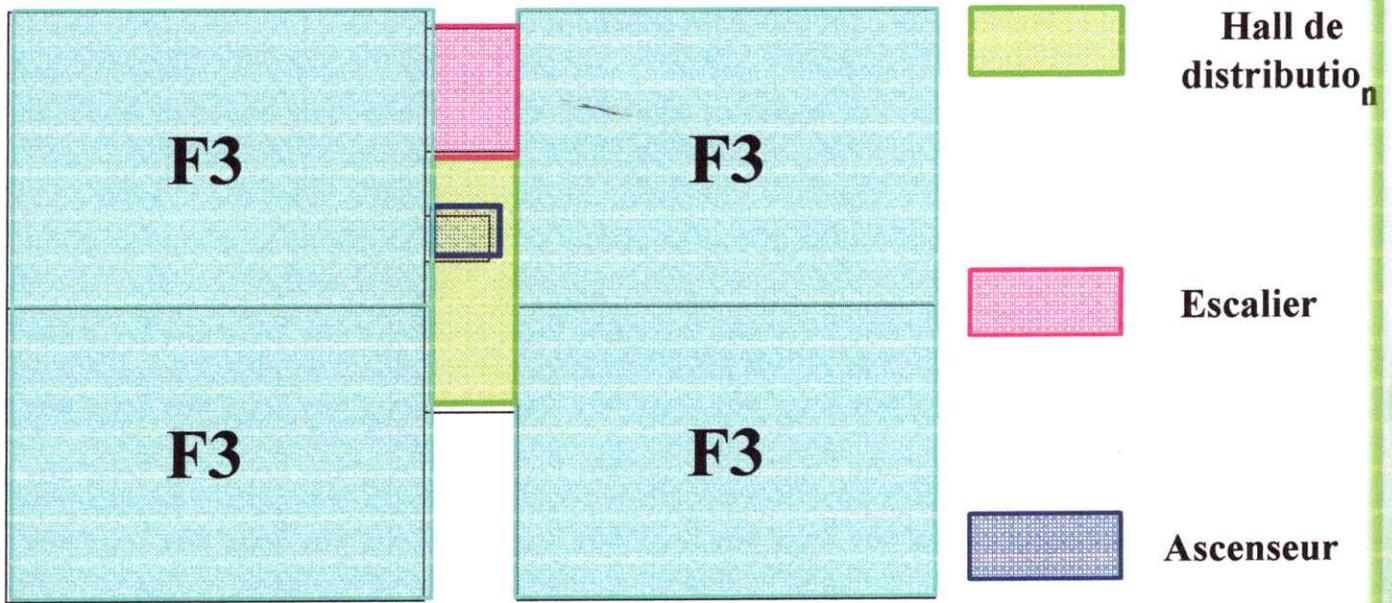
Plan (plot) de REZ – DE –CHAUSSE
